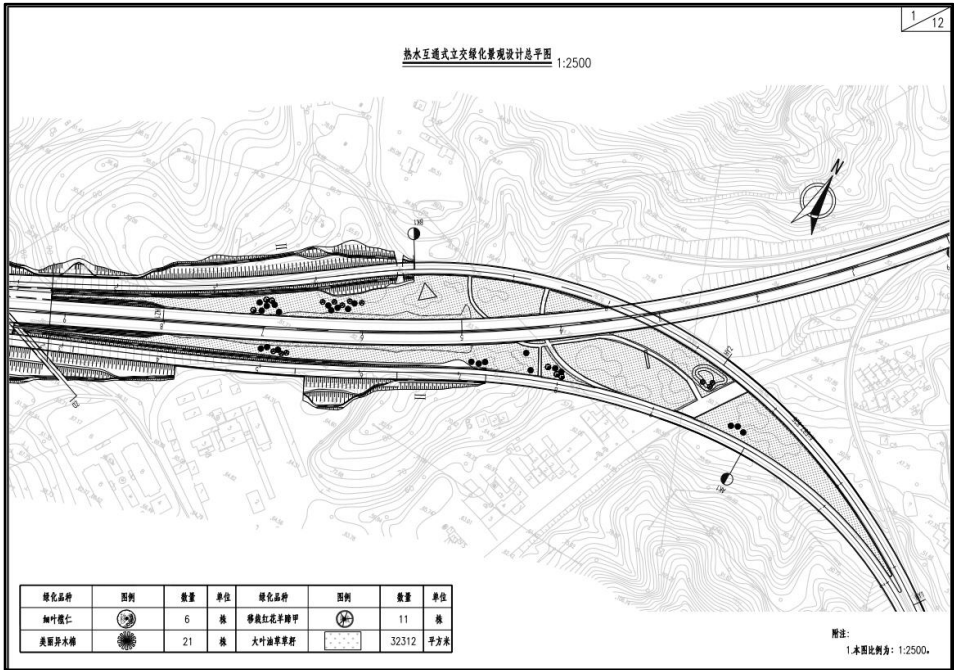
热水枢纽互通景观绿化设计总平面图
